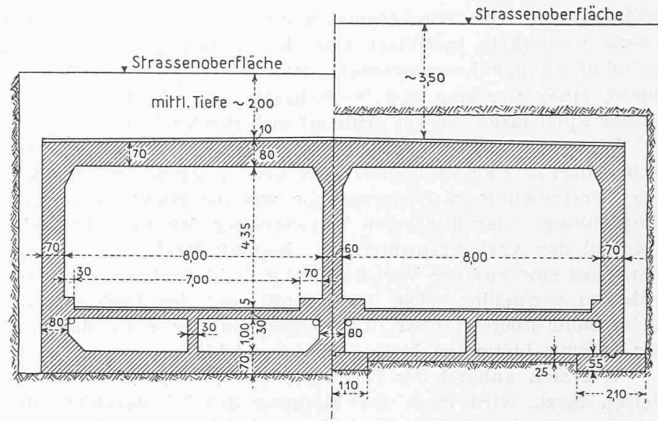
Strassentunnel mit zwei Einrichtungs-Fahrbahnen; links in Schlitzbauweise, rechts in Unterfangungsbauweise dargestellt
